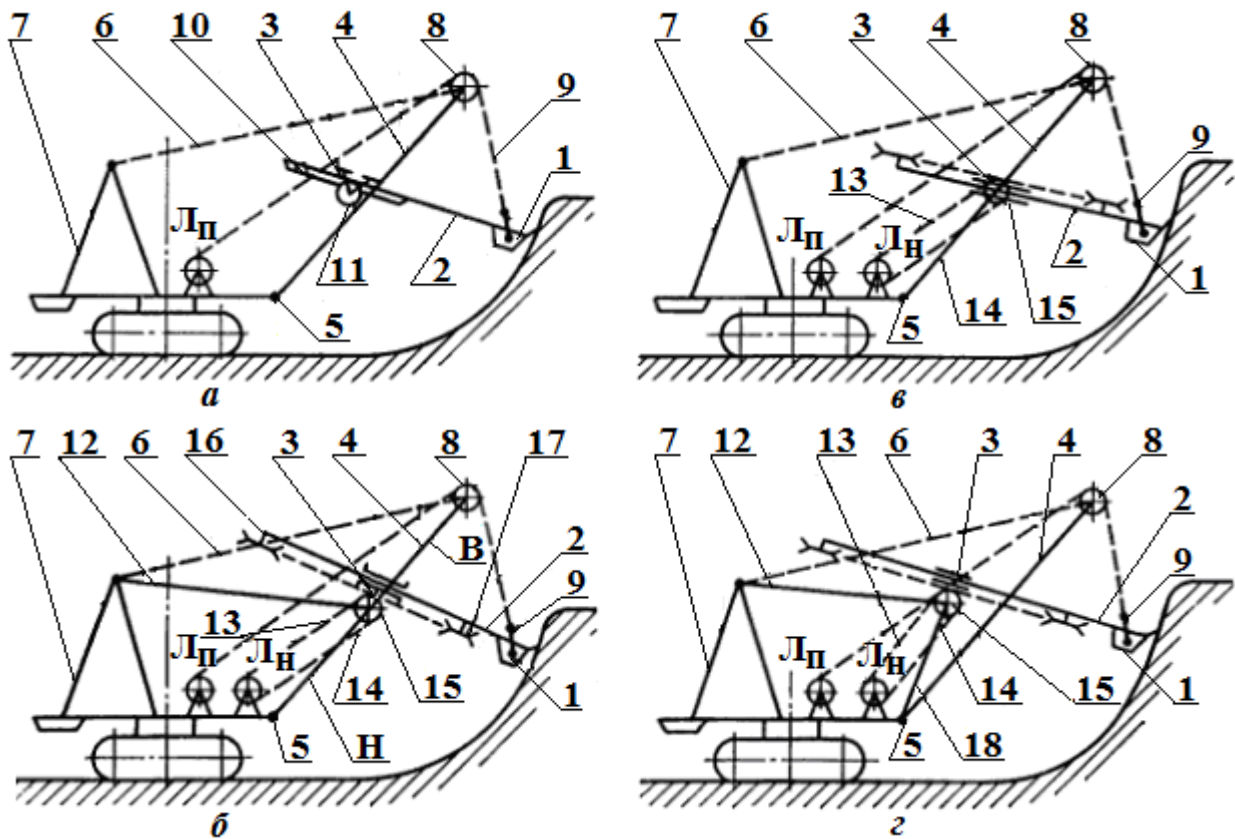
Схеми робочого обладнання одноківшевих екскаваторів з висувною рукояттю: *a* – із зубчасто-рейковим механізмом напору; *б* – з канатним механізмом напору й розрізною стрілою; *в, г* – з канатним механізмом напору й нерозрізною стрілою
